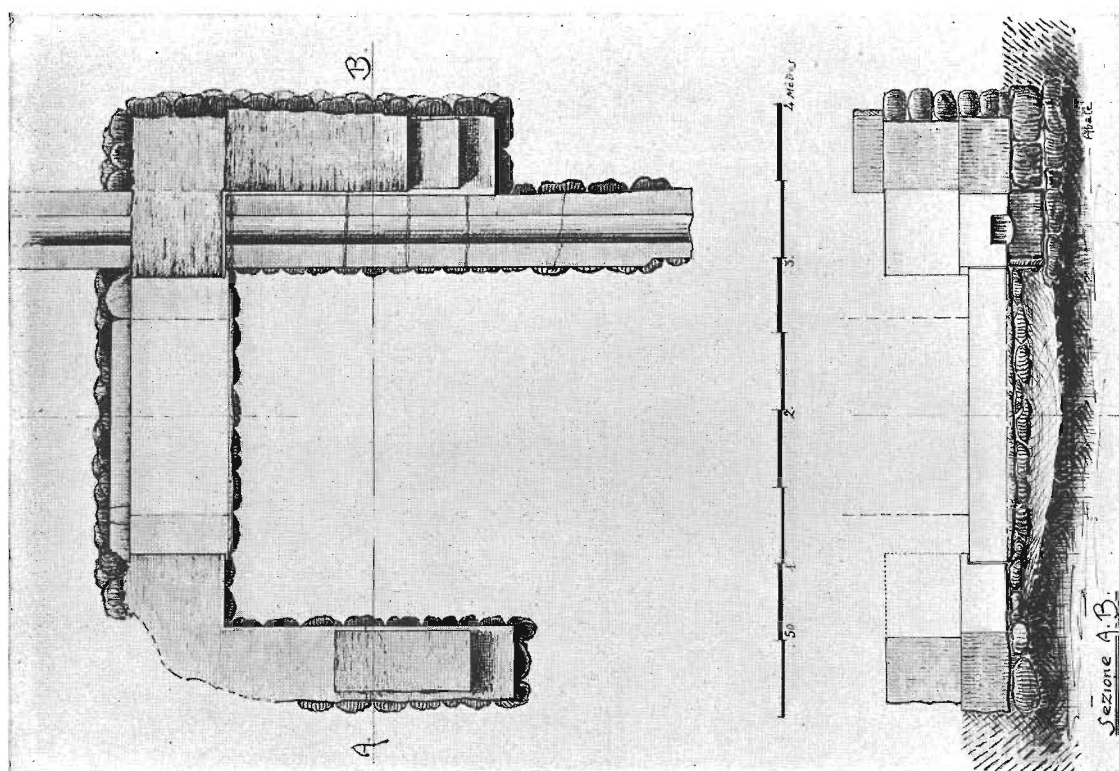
CONSTRUCTION NO. 14. PLAN ET COUPE.
